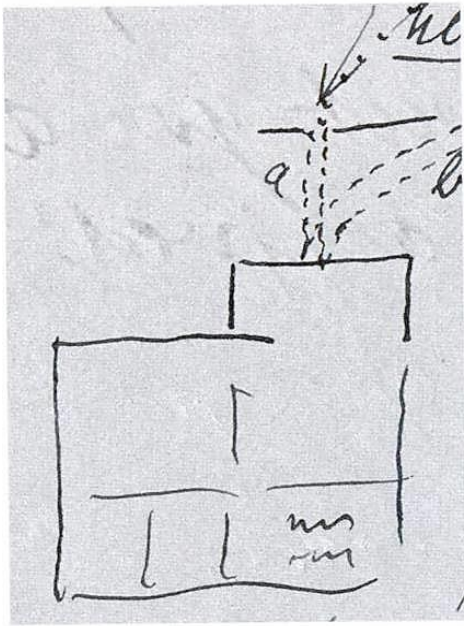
Kurt Schwitters, Grundriss Haus am Bakken, 1947
